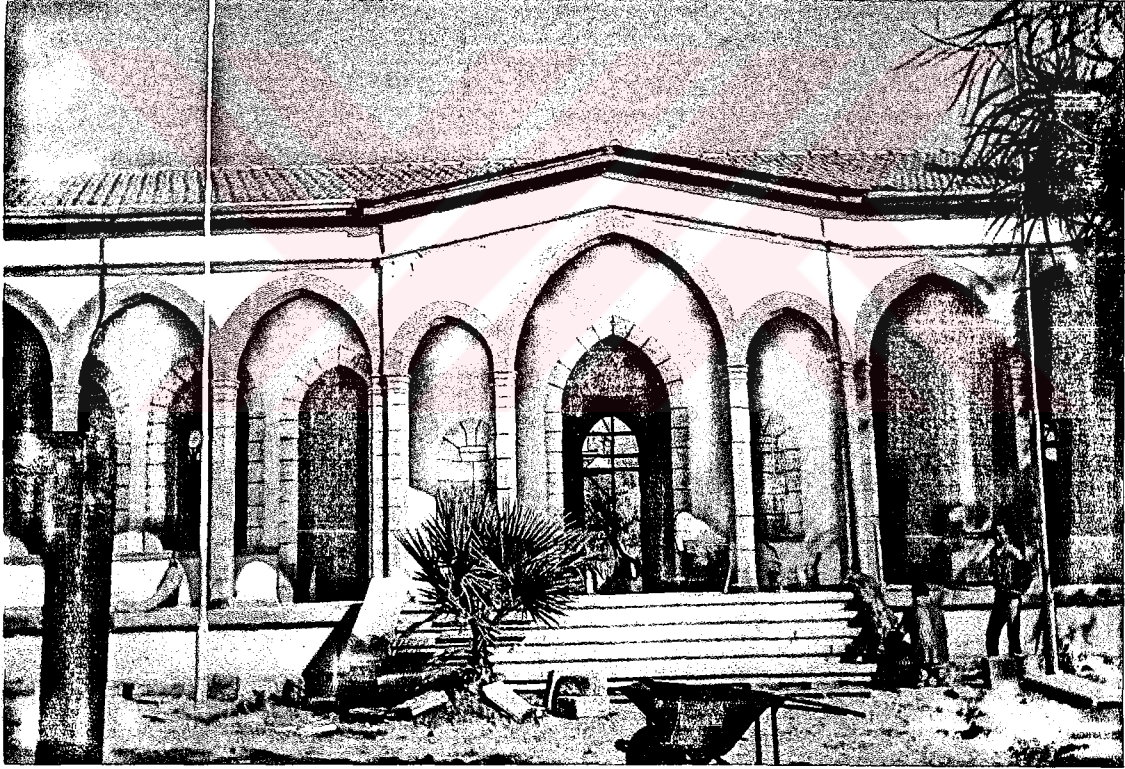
Kirlizade Evi giriş kapısı- 2001 yılı
